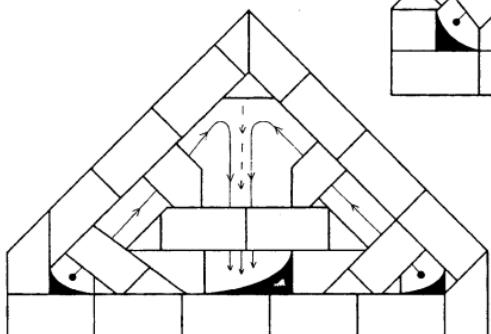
Кладка отопительной треугольной печи № 5 (продолжение)
